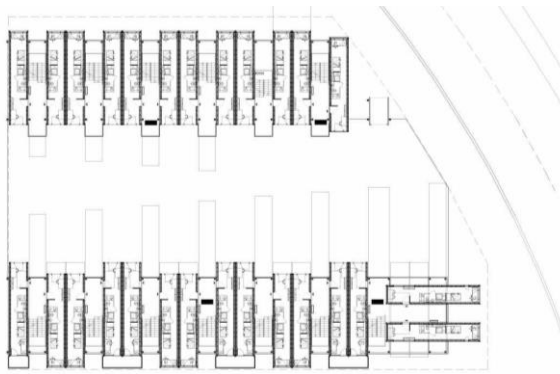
Plan d'assemblage de R+1, R+2 [45]
